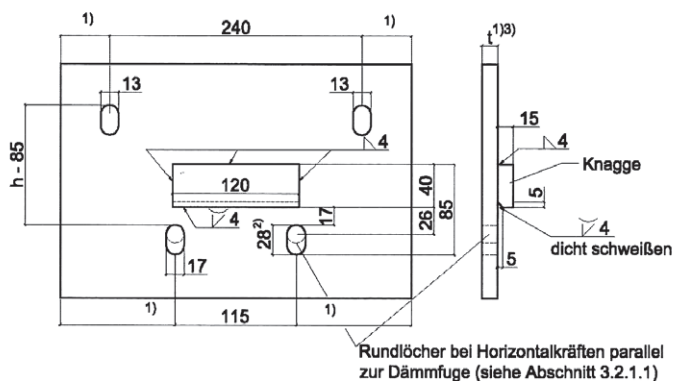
Bauseitige Stirnplatte zu Schöck Isokorb Typ RKS10
